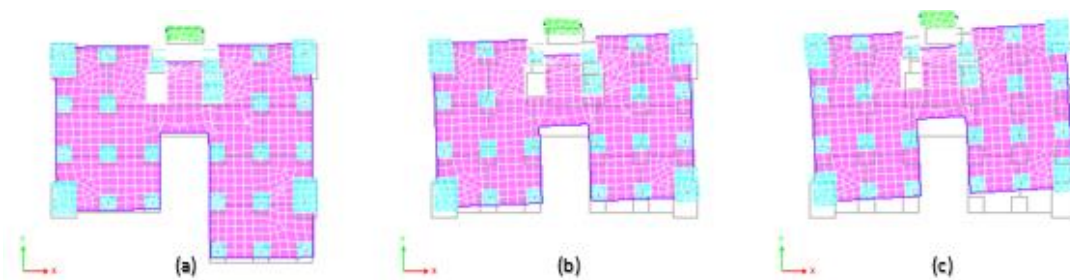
Vista en planta del modo de vibración 2 correspondiente al Caso 3. a) Segunda Planta. b) Quinta Planta. c) Octava Planta.
